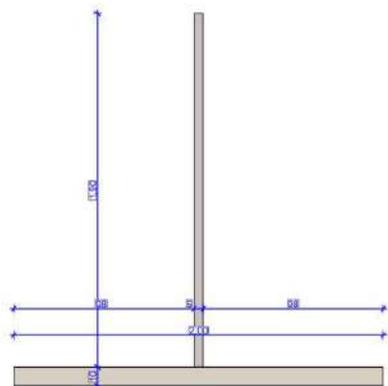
Plan d'élévation de principe du ponton (Source : MAP-oi, 08/04/2024)
